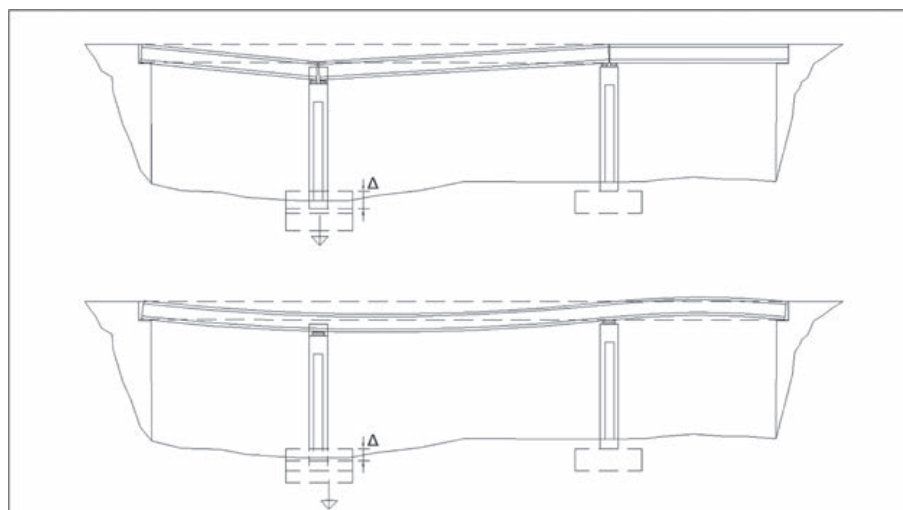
EFECTO DEL ASIENTO DE PILA EN ESTRUCTURA ISOSTÁTICA E HIPERESTÁTICA.
